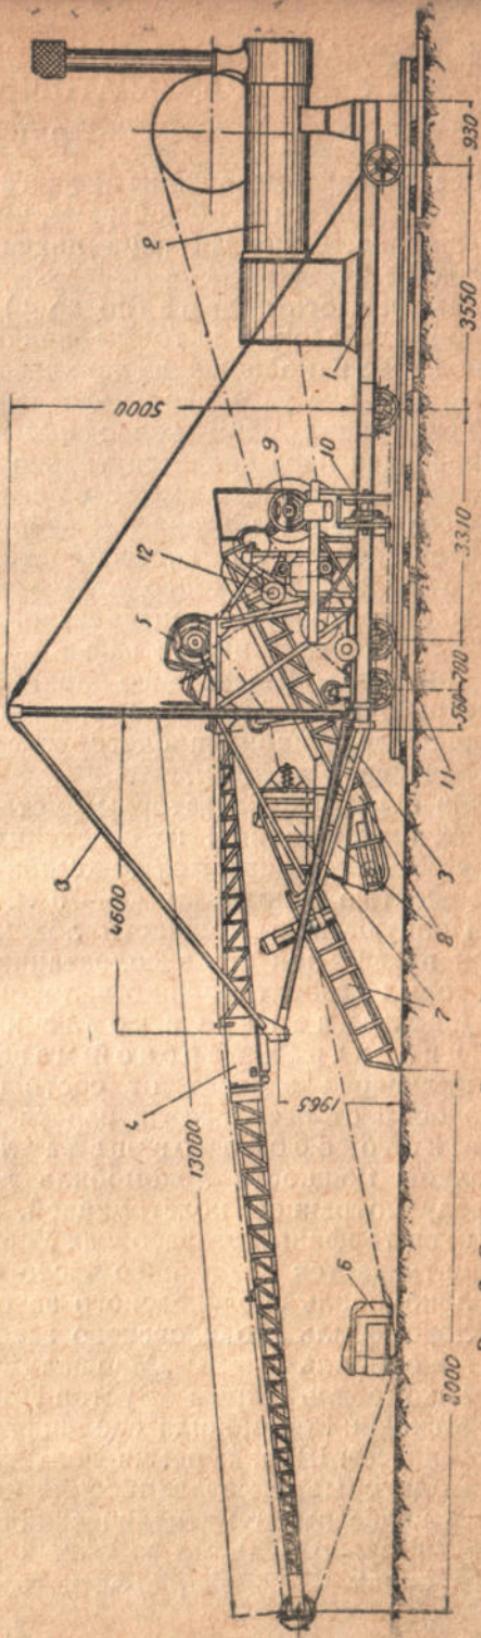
Схематический общий вид скреперно-элеваторной установки СЭ-3.
